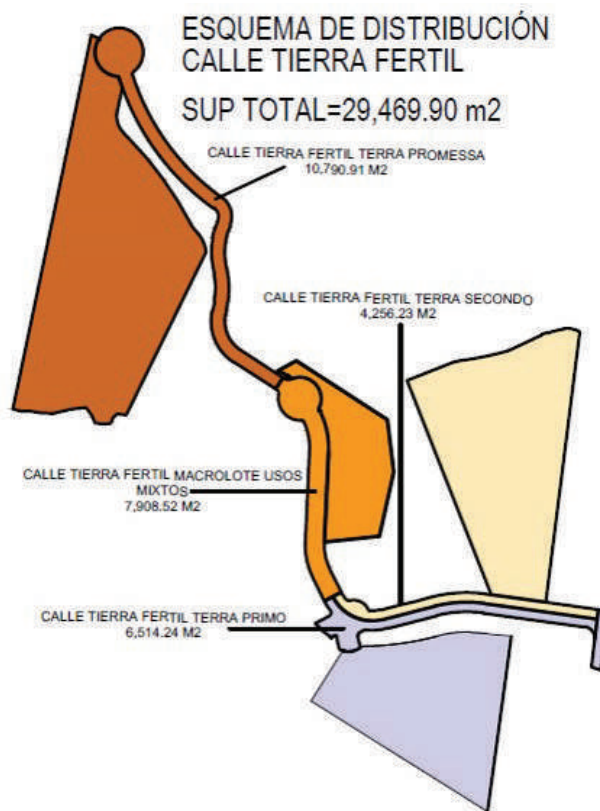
Esquema de distribución de calle Tierra Fértil. Fuente: Proyecto geométrico Terra Promessa.
